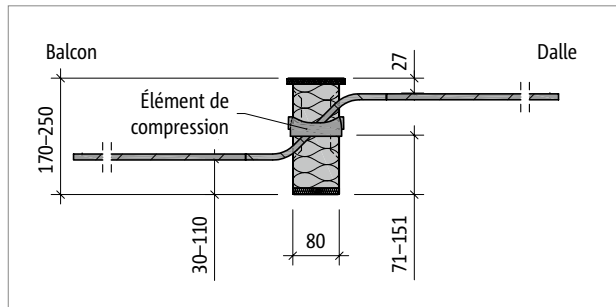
Schöck Isokorb® T Type Q-E-V5 : Coupe du produit
